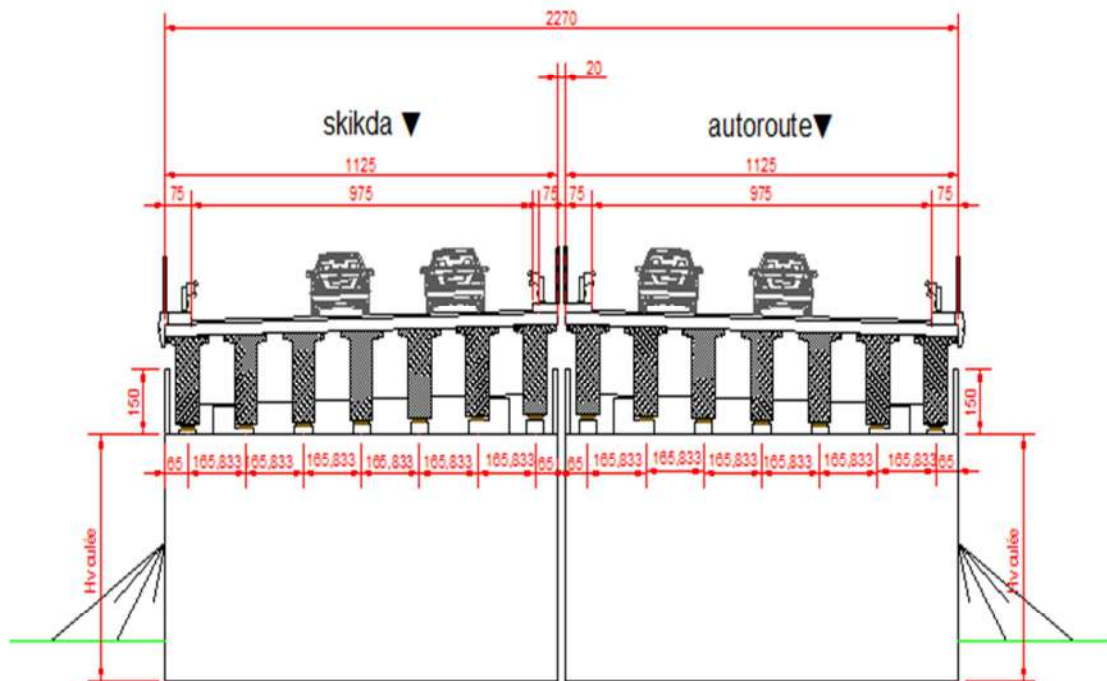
coupe transversale sur cule du pont a poutre précontrainte
